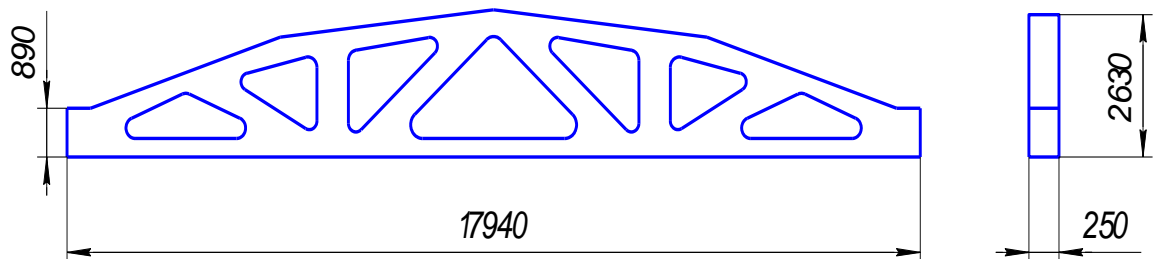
Габаритные размеры железобетонных ферм серии 1.463-3
